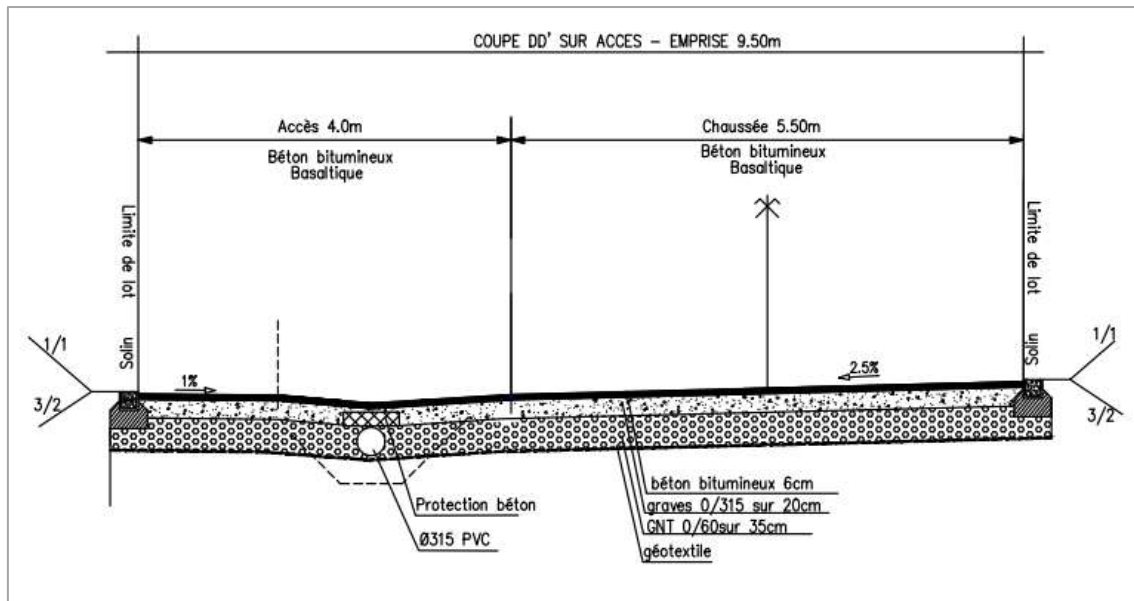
b : profil type de chaussée voie secondaire avec collecteur EP sous chaussée (Source : PA2, Geoval)
